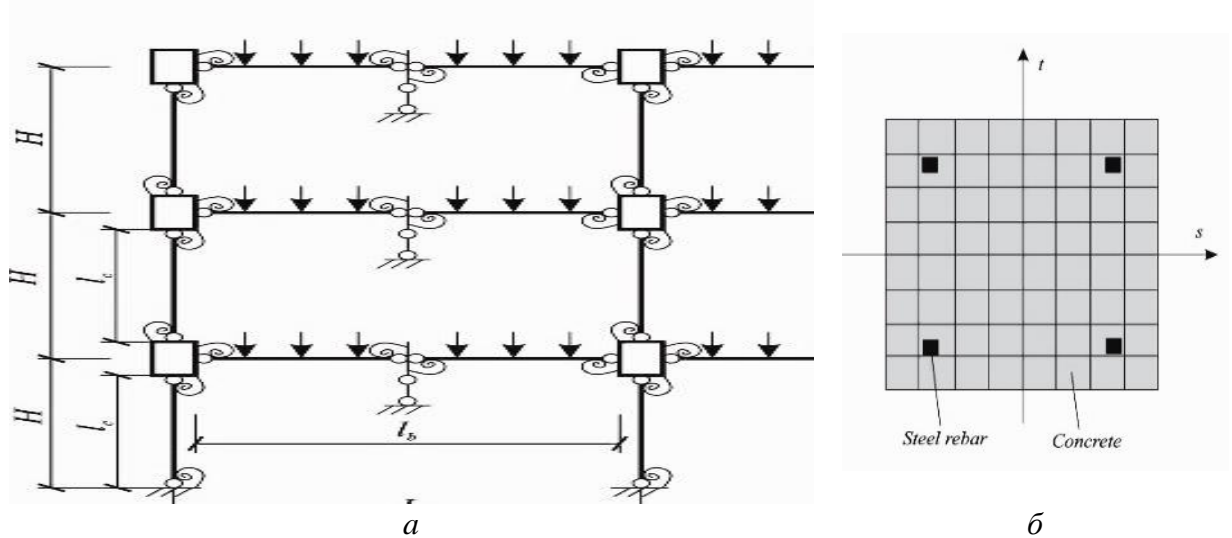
Расчетная схема метода перемещений для расчета устойчивости железобетонных каркасов зданий при структурных перестройках, вызванных особым воздействием: а) общий вид схемы, б) структурный элемент
